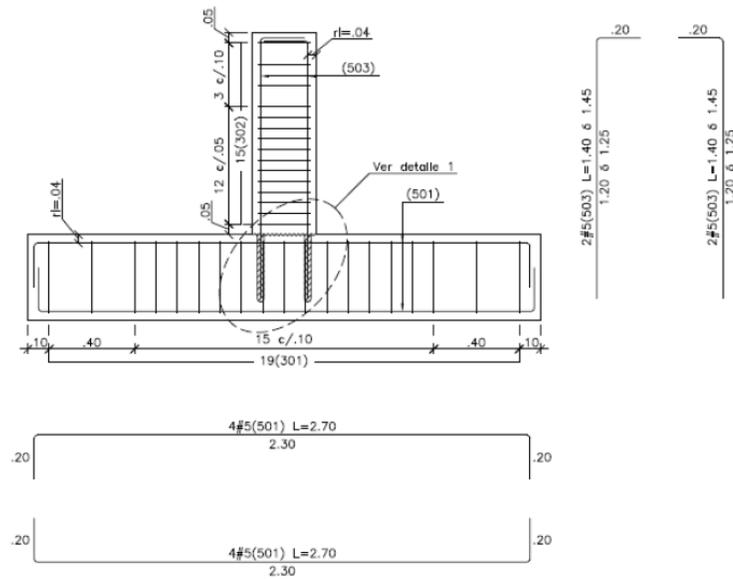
Detalle de refuerzo de unión viga columna con refuerzo anclado
